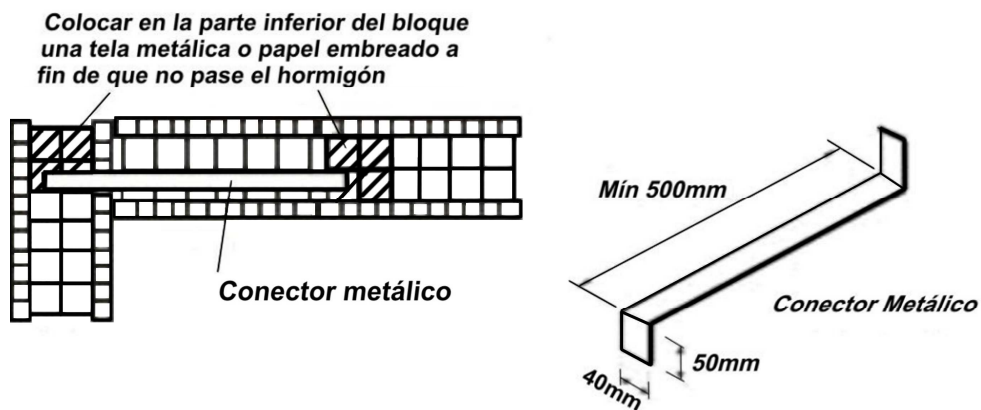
Conector metálico de anclaje en encuentro de muros.
